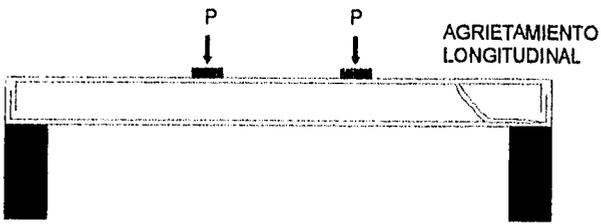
II MECANISMO DE AGRIETAMIENTO DE FALLAS POR FLEXIÓN.
